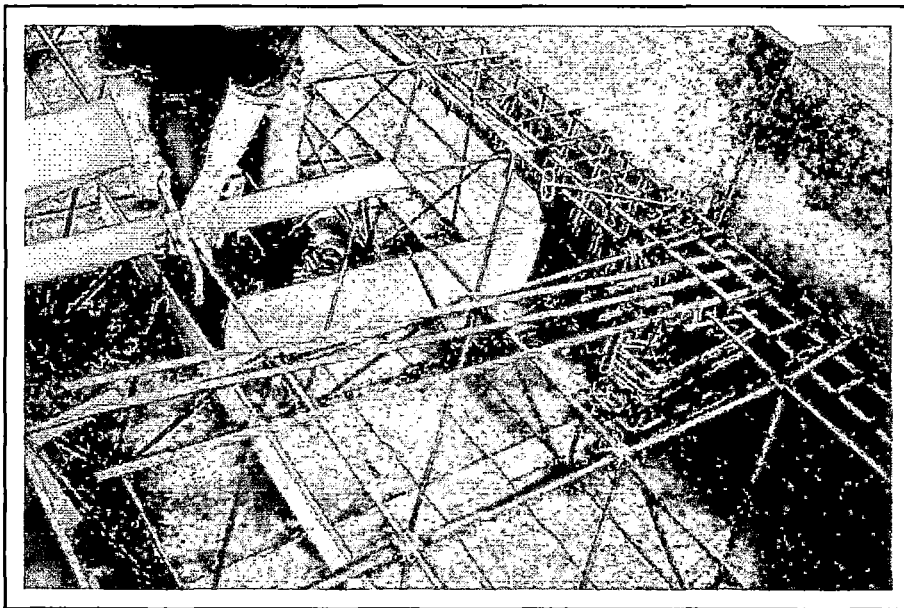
Proceso de colocación del encofrado perimetral de la tridilosa
